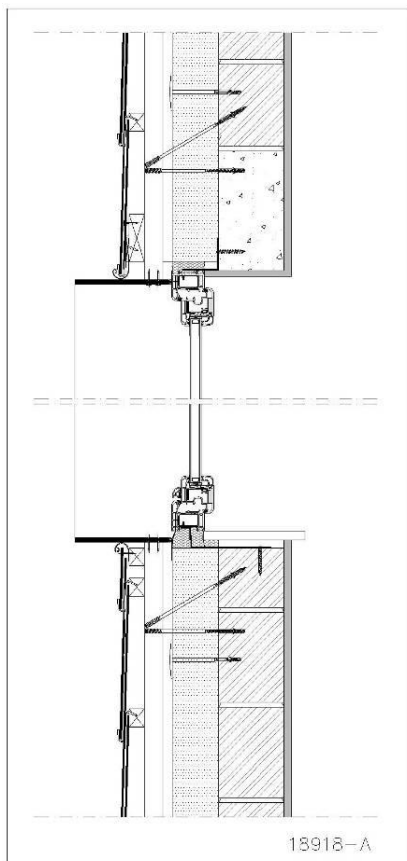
Exemple coupe verticale d'une fenêtre en retour
